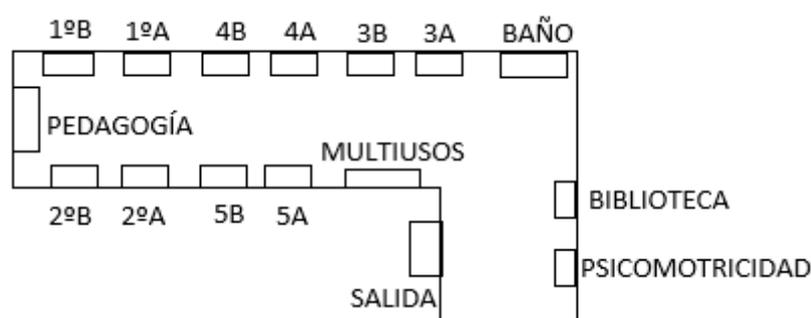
Planta de Educación Infantil del colegio concertado Santa María Micaela.
